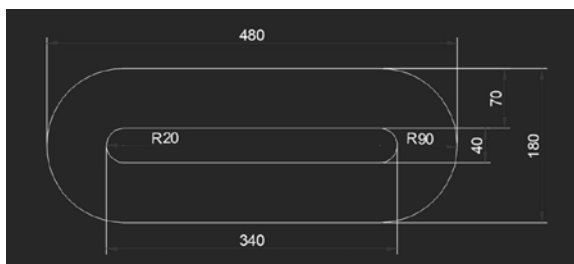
Planta baixa do tanque utilizado para os estudos.
